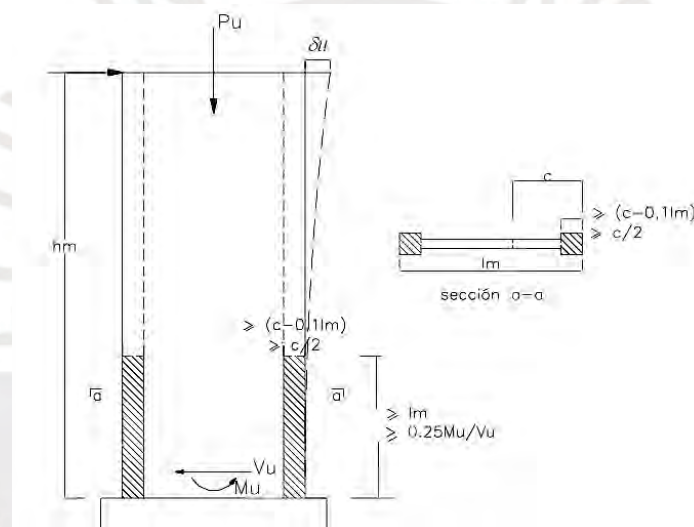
Disposiciones para confinamiento en elementos de borde en muros
